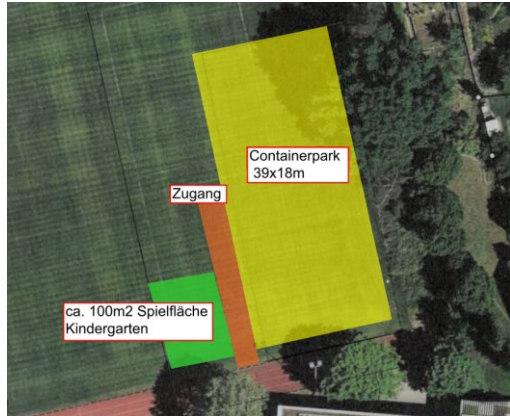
Situationsplan der geplanten Containeranlage mit Spielfläche auf dem Rasenplatz
